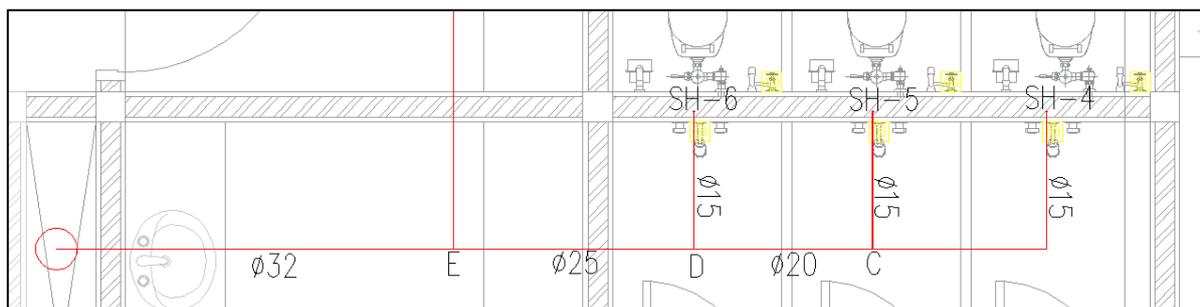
Jalur Pipa Air Bersih Dingin Lantai 1
